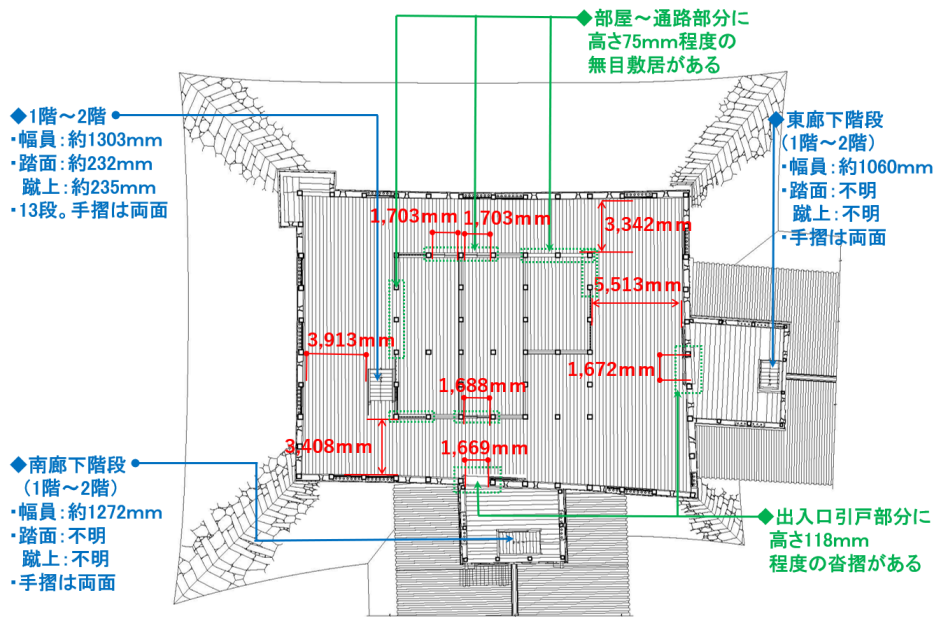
天守1階平面図及び東廊下・南廊下2階平面図（復元原案）
